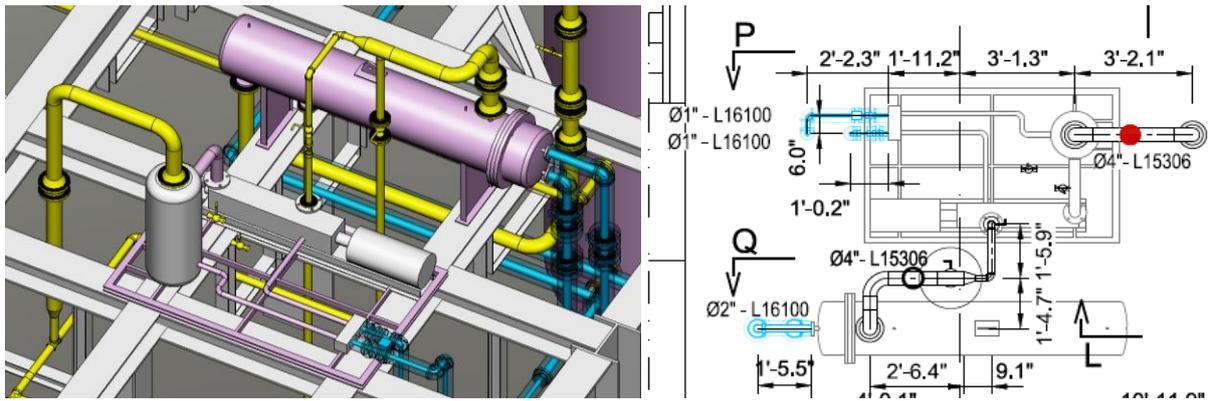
Modelo LOD350 dos equipamentos e extração 2D: localização das ligações às tubagens e apoios para estrutura metálica.
